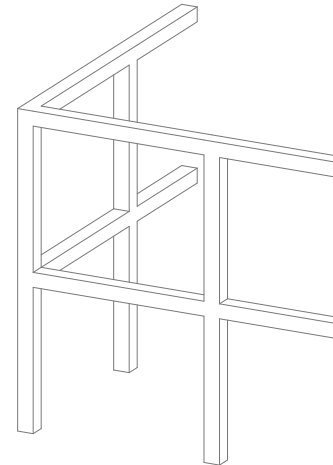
Esquema estructural con vigas y columnas de hormigón.
